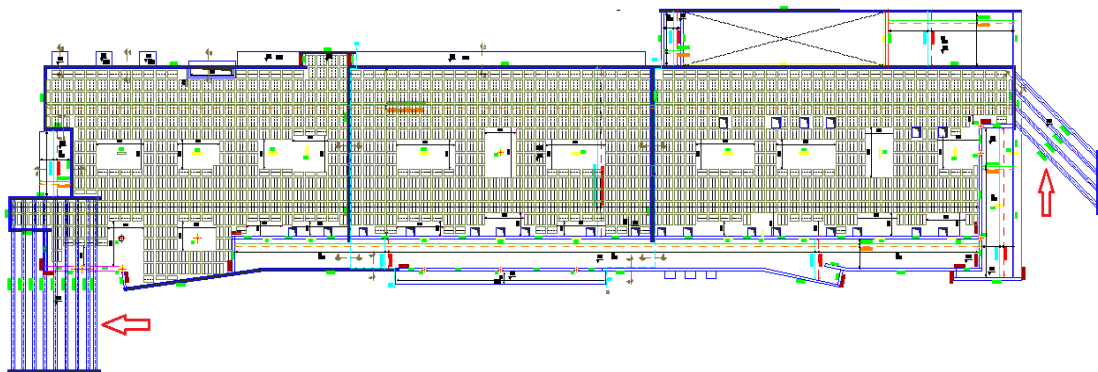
Localização das coberturas mais elevadas (Fonte: Projeto de Estrutura)
